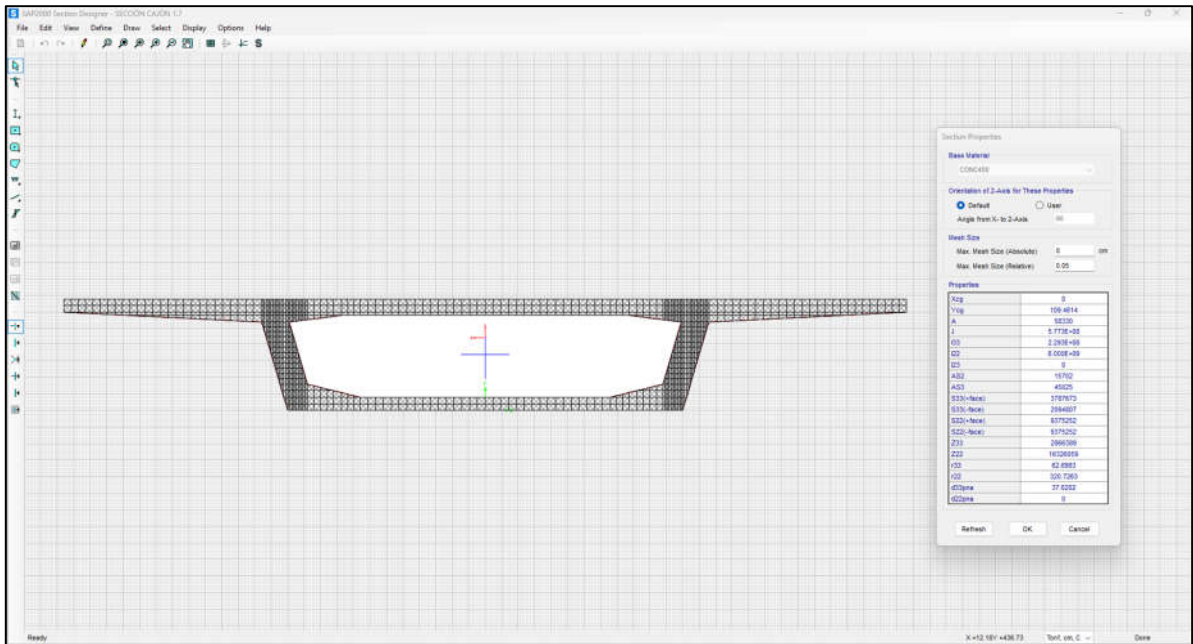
Sección Transversal y características geométricas de la sección simple
